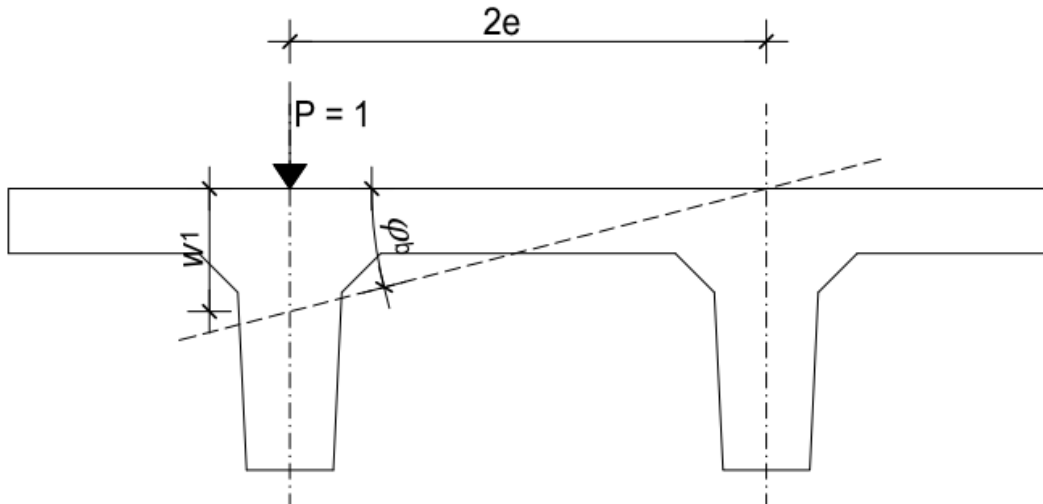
Sudjelujuća širina rebraste TT ploče međukatne konstrukcije.
